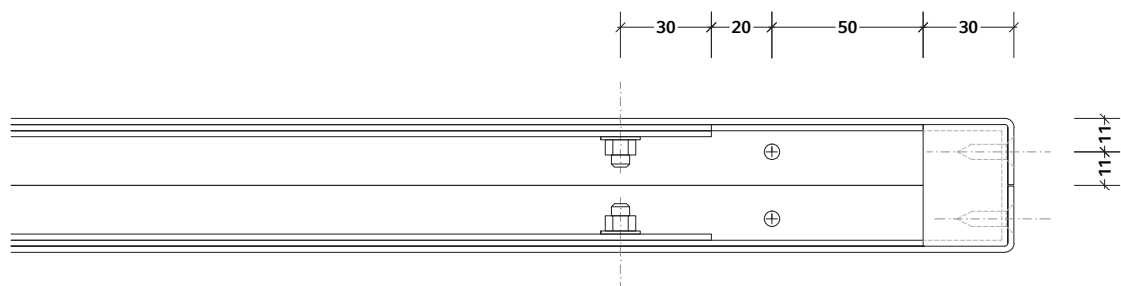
Gebäudekennzeichnung mit Standrohr Detail 02
